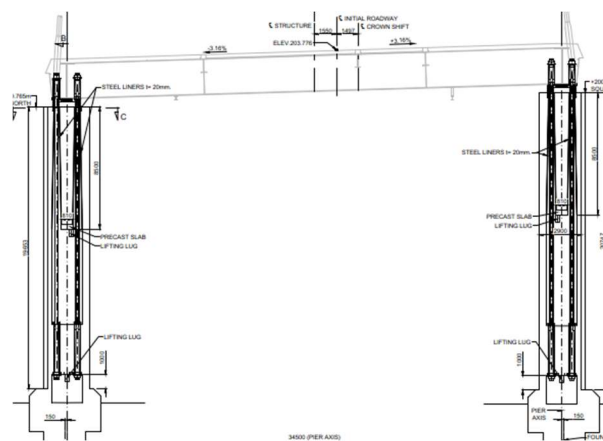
Pilas de retenida P11 a P14 con dos fustes independientes
